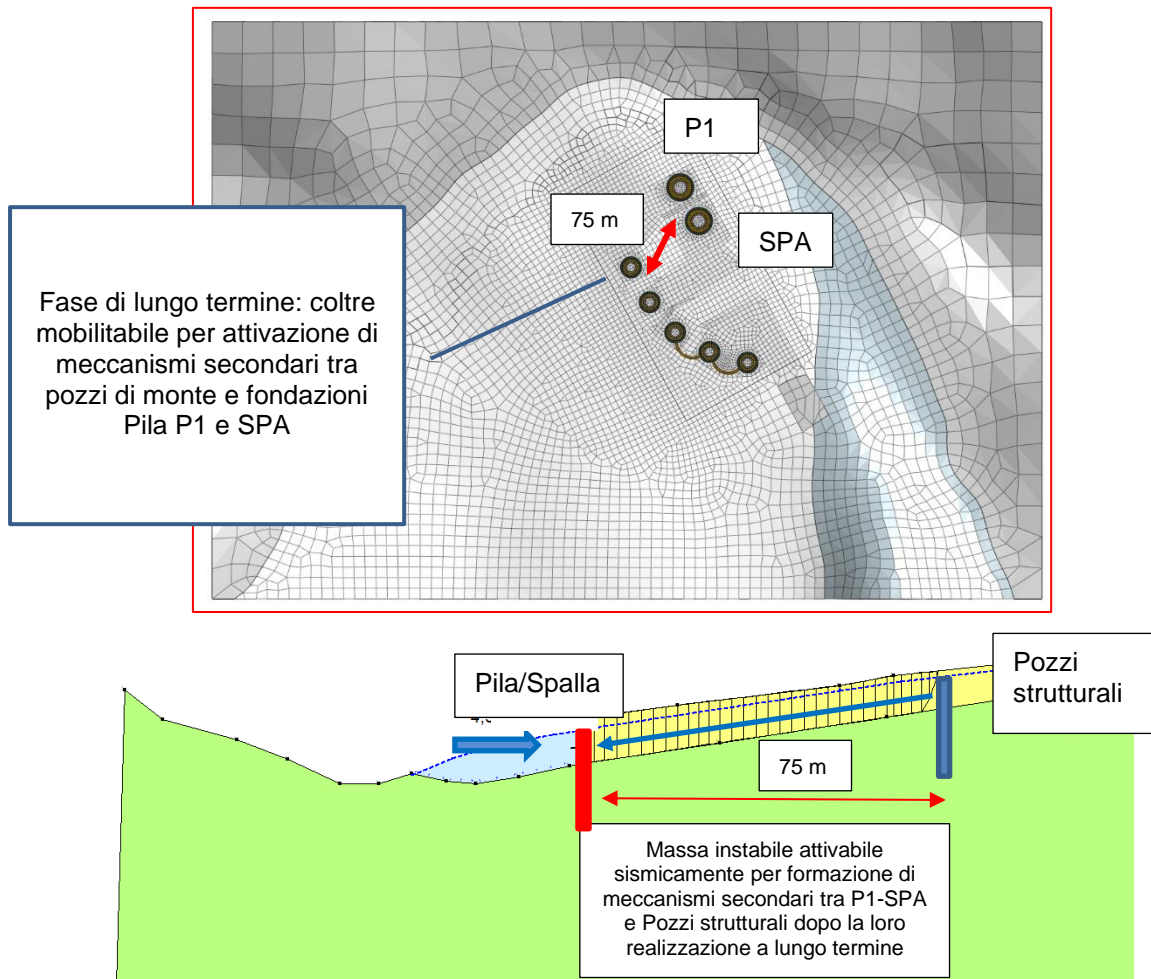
Schema concettuale per la determinazione delle spinte di frana su Pila 1 e spalla A a lungo termine
